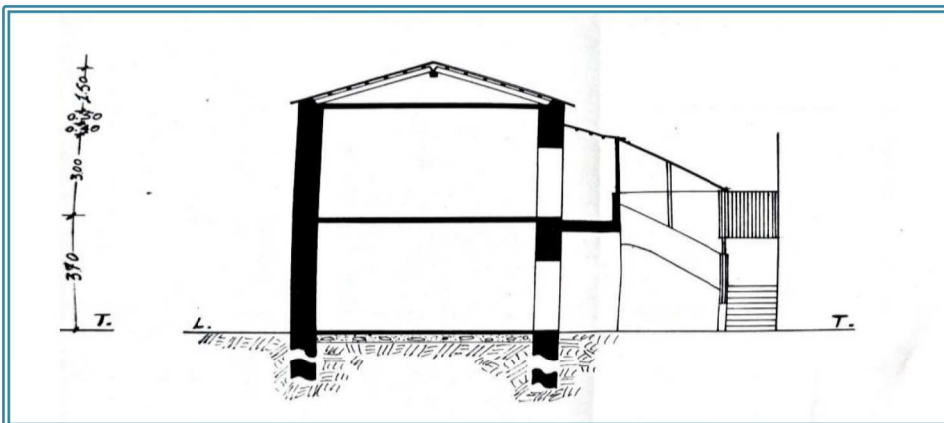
Sezione (post operam) – estratto dal fascicolo pratica di costruzione edile n. 5951 del 17.03.1988
